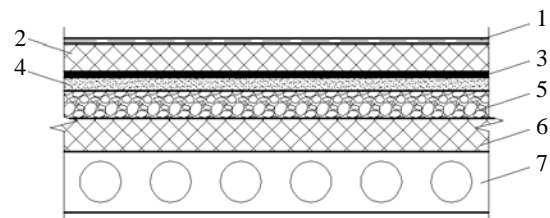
Рекомендуемое конструктивное решение кровли для выполнения реабилитации: 1 – водоизоляционный ковер из ПВХ-мембраны; 2 – теплоизоляционный слой из сверхжестких минераловатных плит (по расчету); 3 – рулонный водоизоляционный ковер (существующий); 4 – цементно-песчаная стяжка (существующая); 5 – слой керамзитового гравия по уклону (существующий); 6 – слой теплоизоляции (существующий); 7 – железобетонная многопустотная плита покрытия (существующая)
